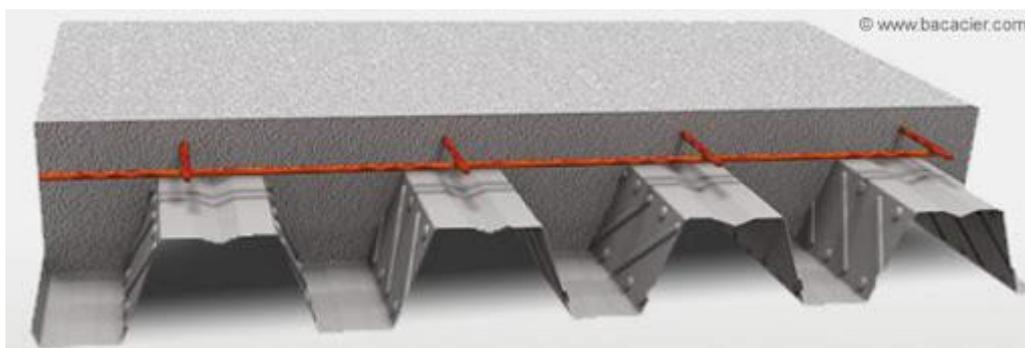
Plancher collaborant. Source : <http://www.eti-construction.fr/1-utilisation-pratique-du-plancher-collaborant-10696/>
